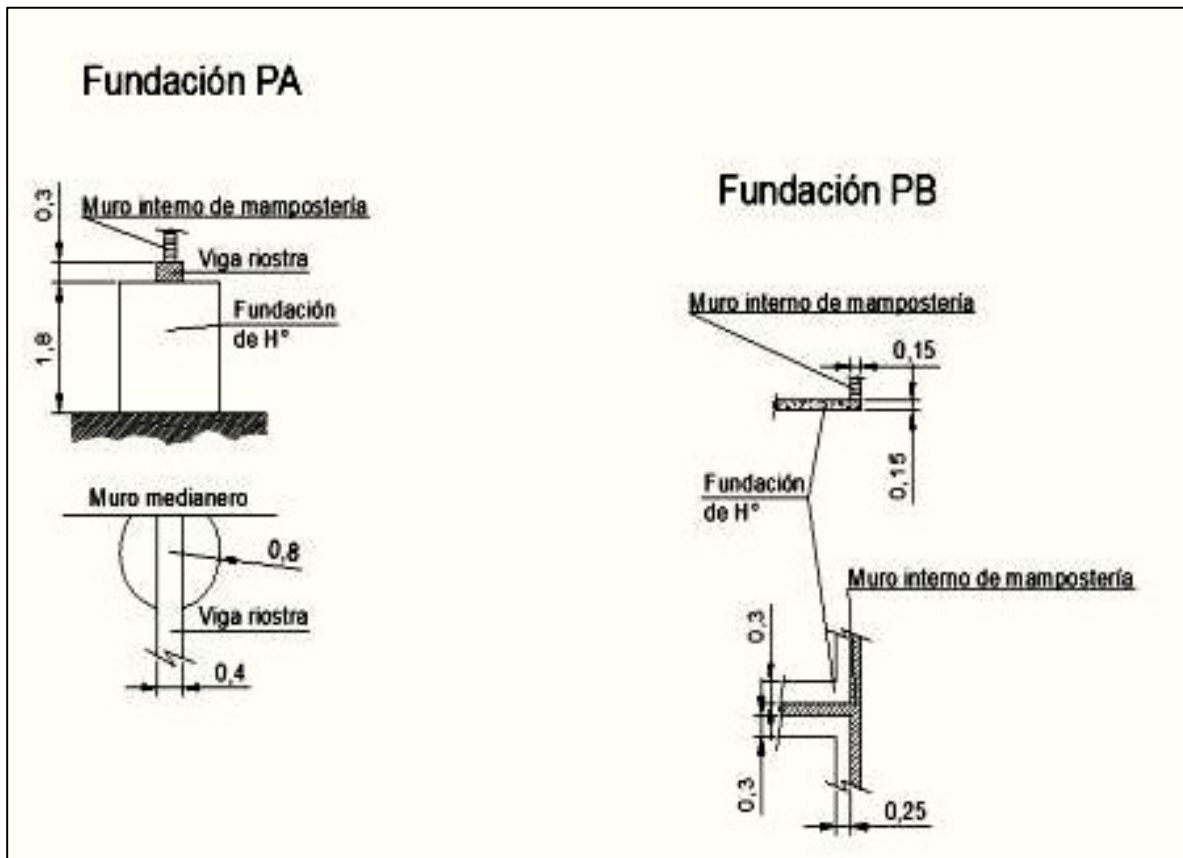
Esquema de la fundación y vigas riostras relevadas en el pozo PB.
